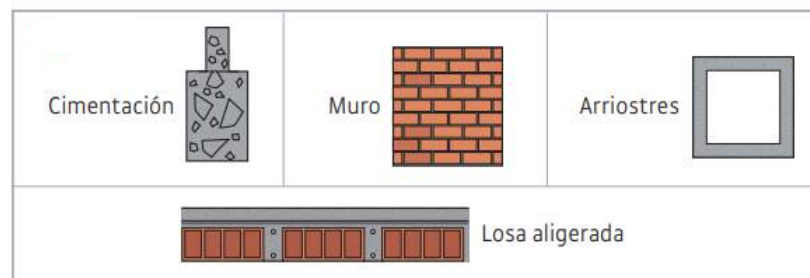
Elementos de una albañilería confinada (Manual de Construcción para Maestros, 2010, p.8)
